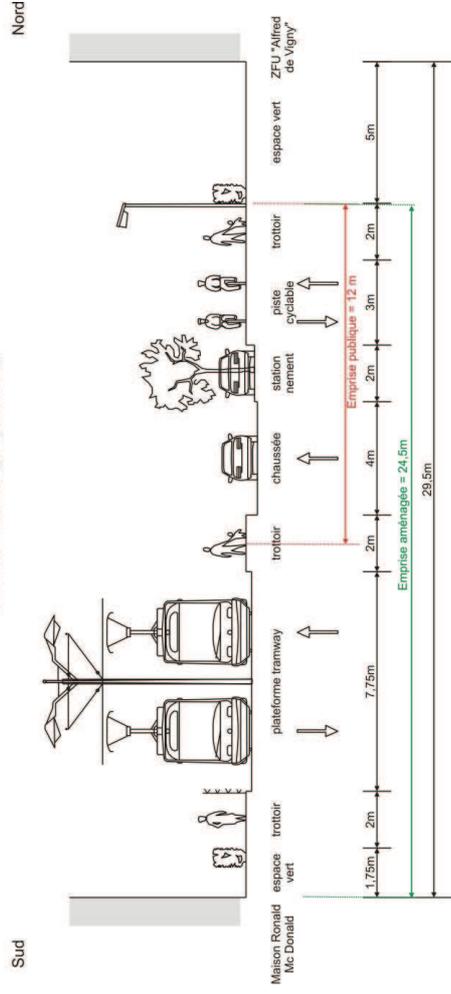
Situation projetée coupe 1 sur l'avenue Molière
